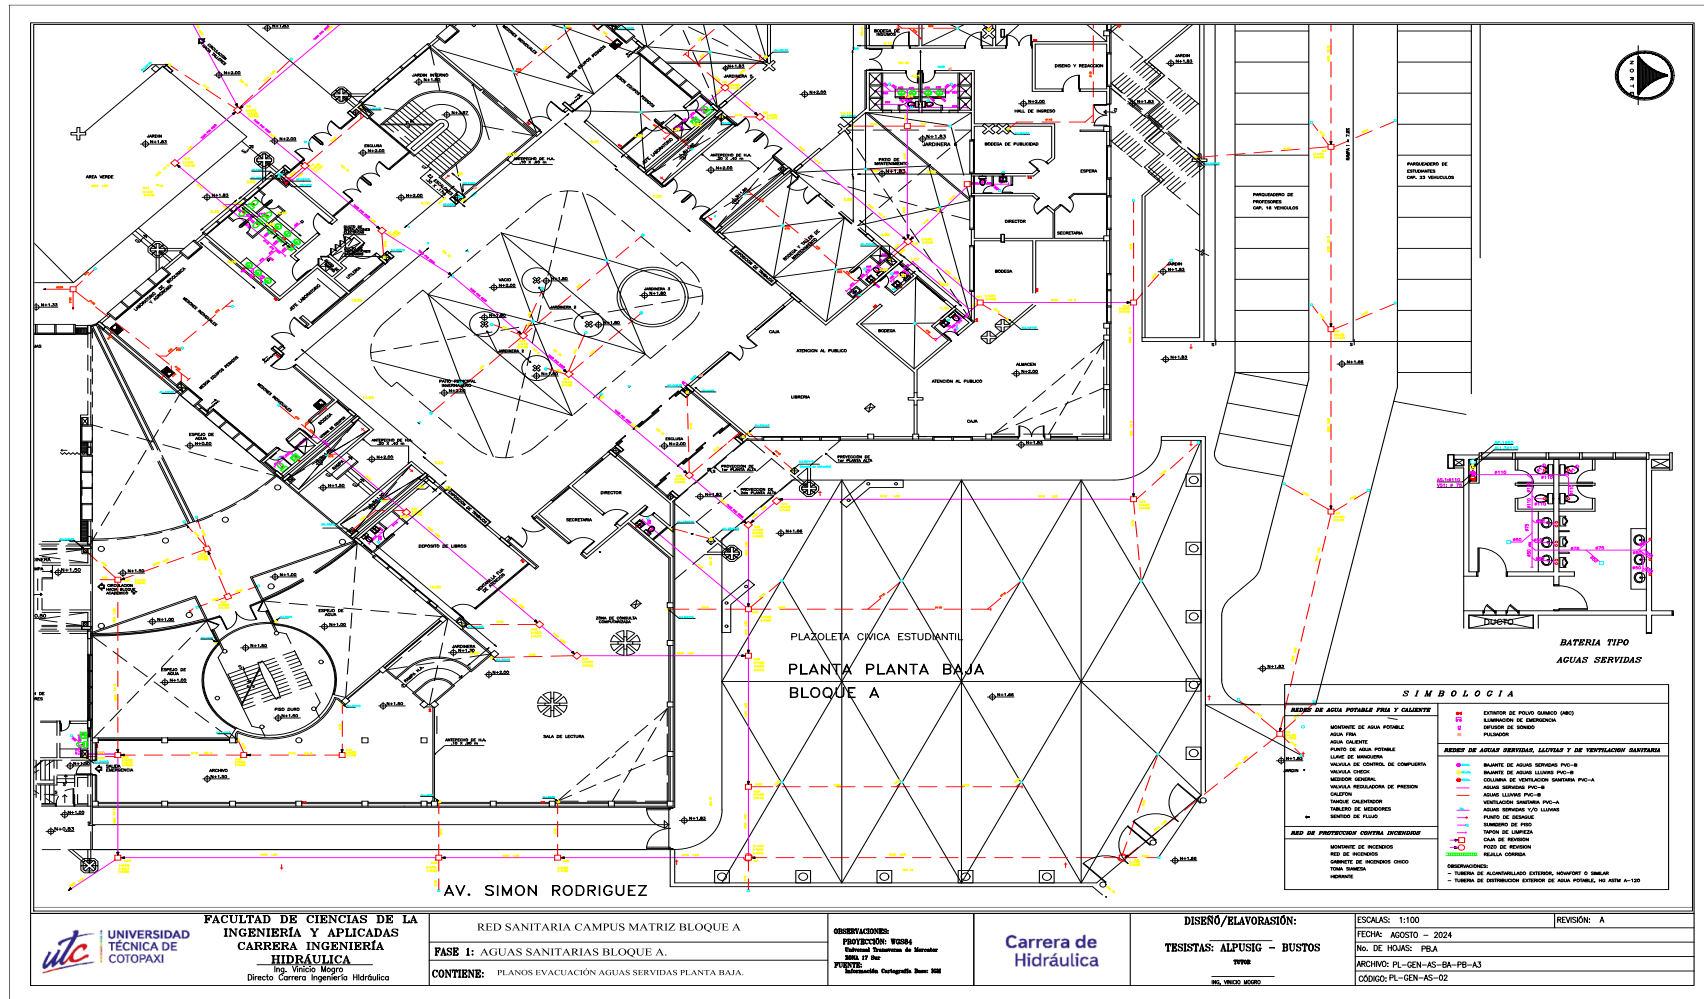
Planos de Aguas Servidas Planta Baja Bloque A.
